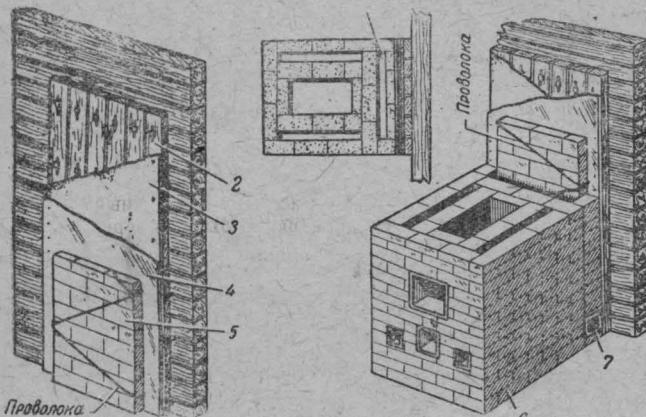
Устройство закрытой отступки с холодной четвертью для печи:
